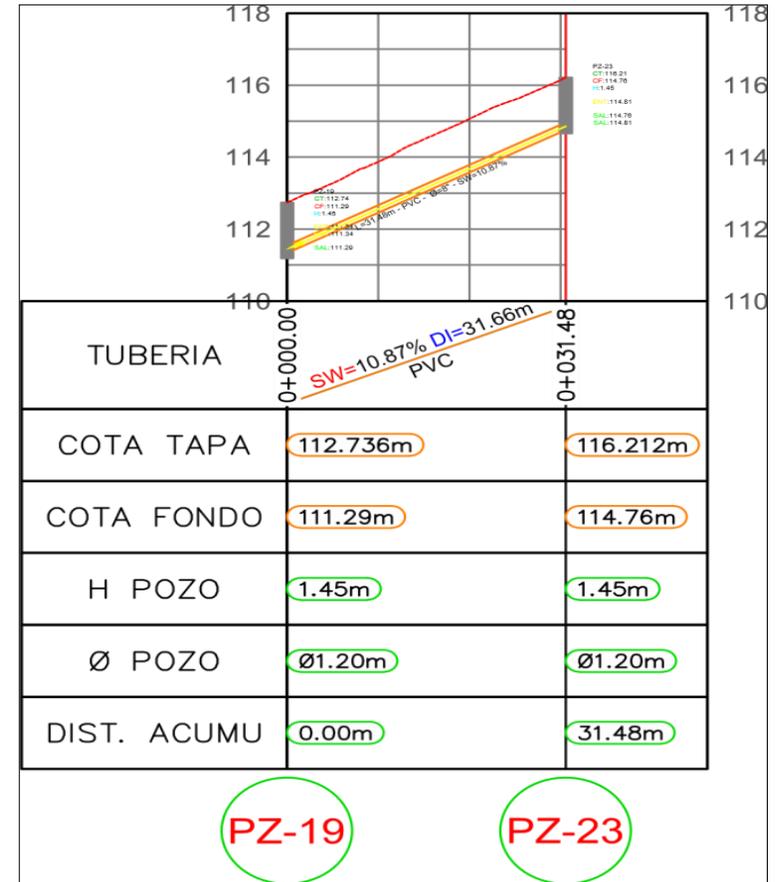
Perfil longitudinal, calle 16-1 Y 16-2
